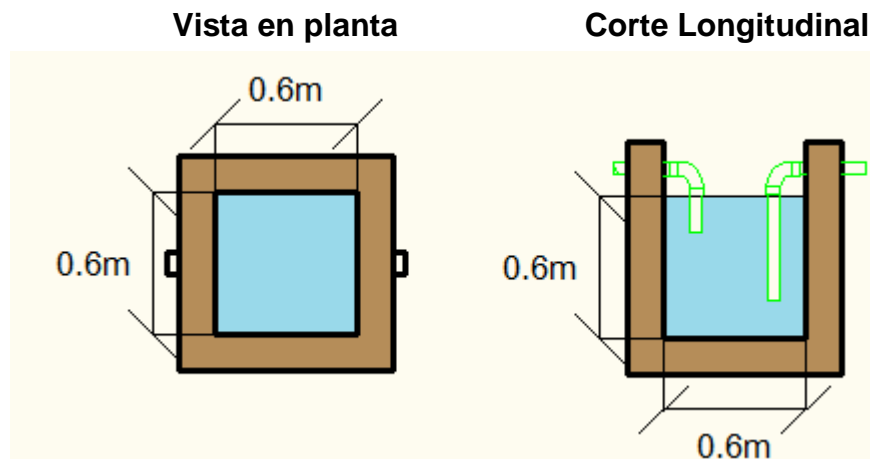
Vista planta y corte longitudinal de la Trampa de Grasas.
